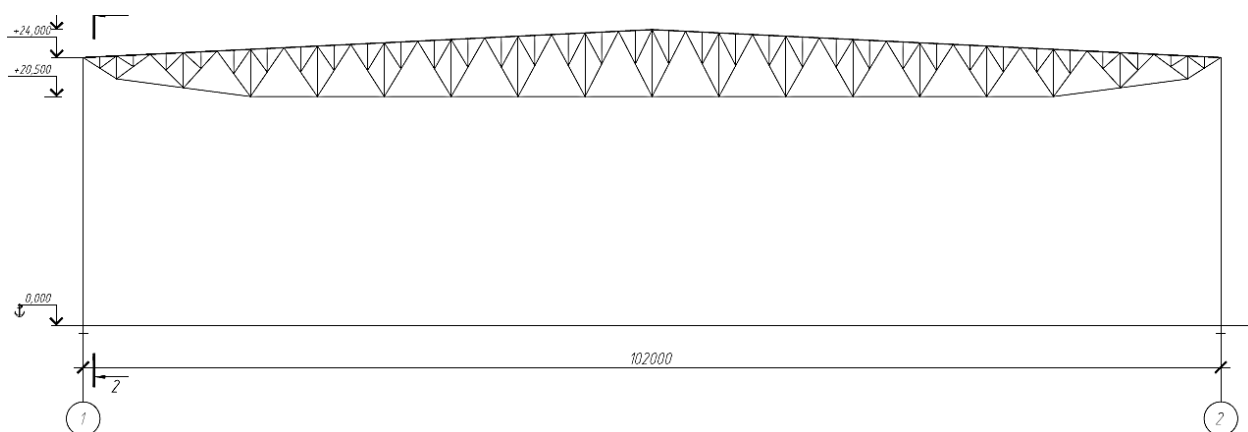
Варіант із балковим покриттям із трапецієподібних ферм
